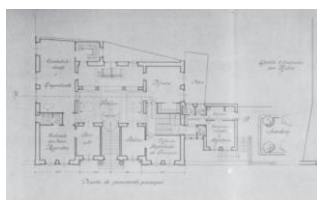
Planta do piso térreo da Sede do Banco de Portugal. (Damásio, 2013)
